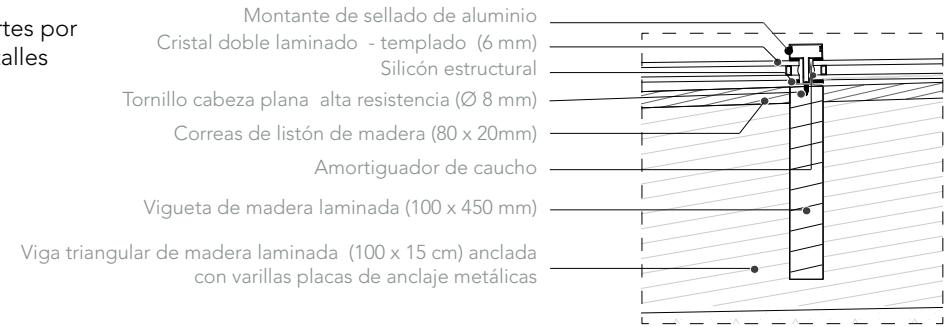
Detalles constructivos, D-3 Fuente: elaboración propia, 2024.
